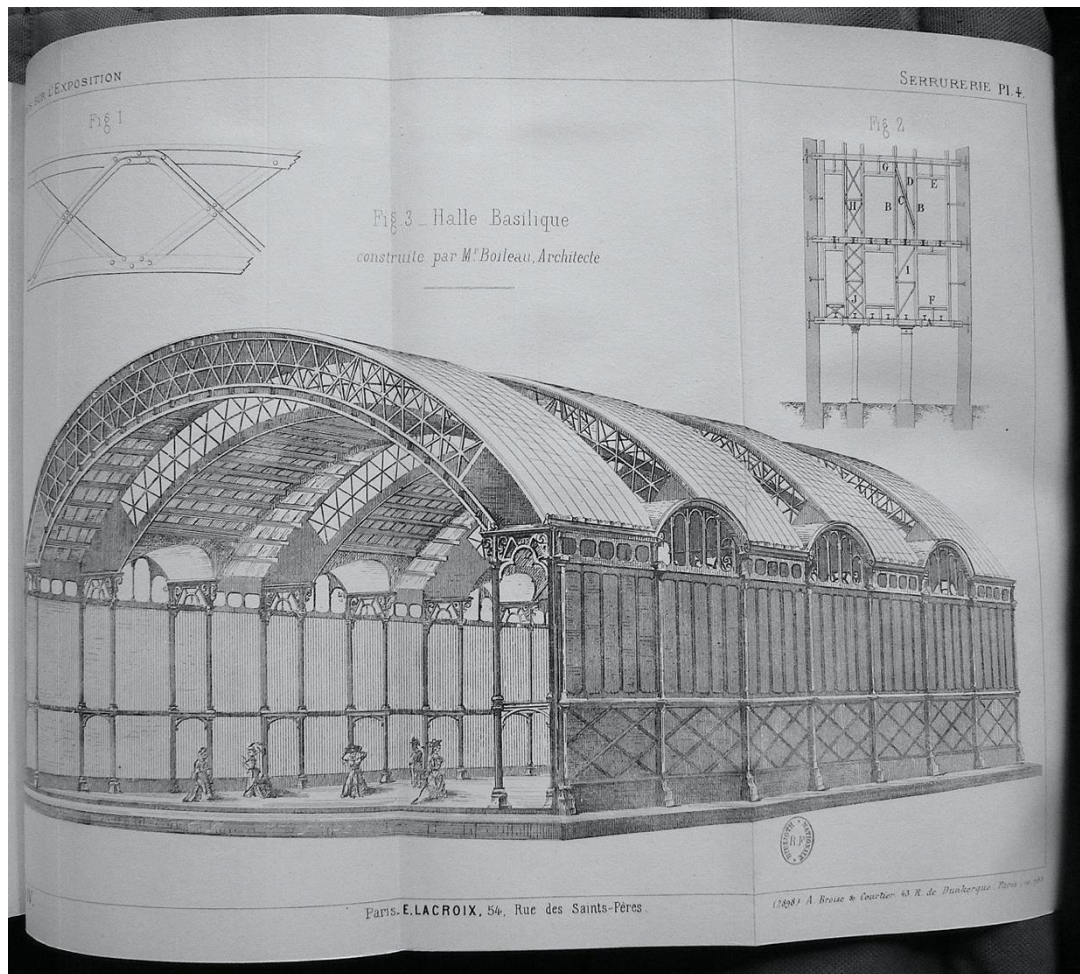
17 : Halle basilique construite par M. Boileau.
